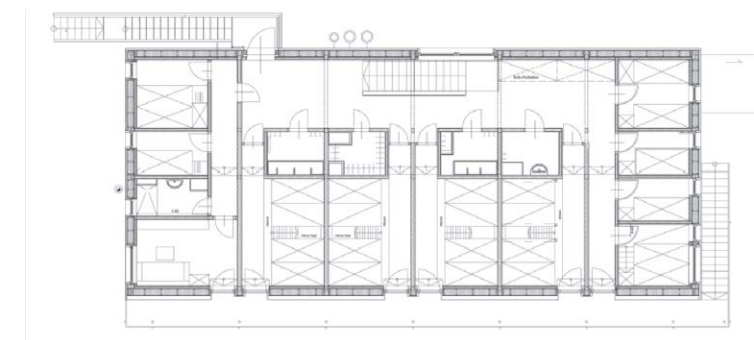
Pianta piano terra del rifugio Schiestlthaus
